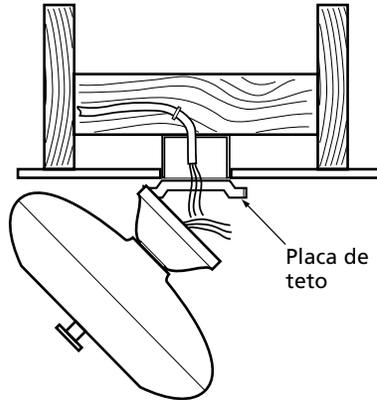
Ventilador montado pendendo dos ganchos da placa de teto
